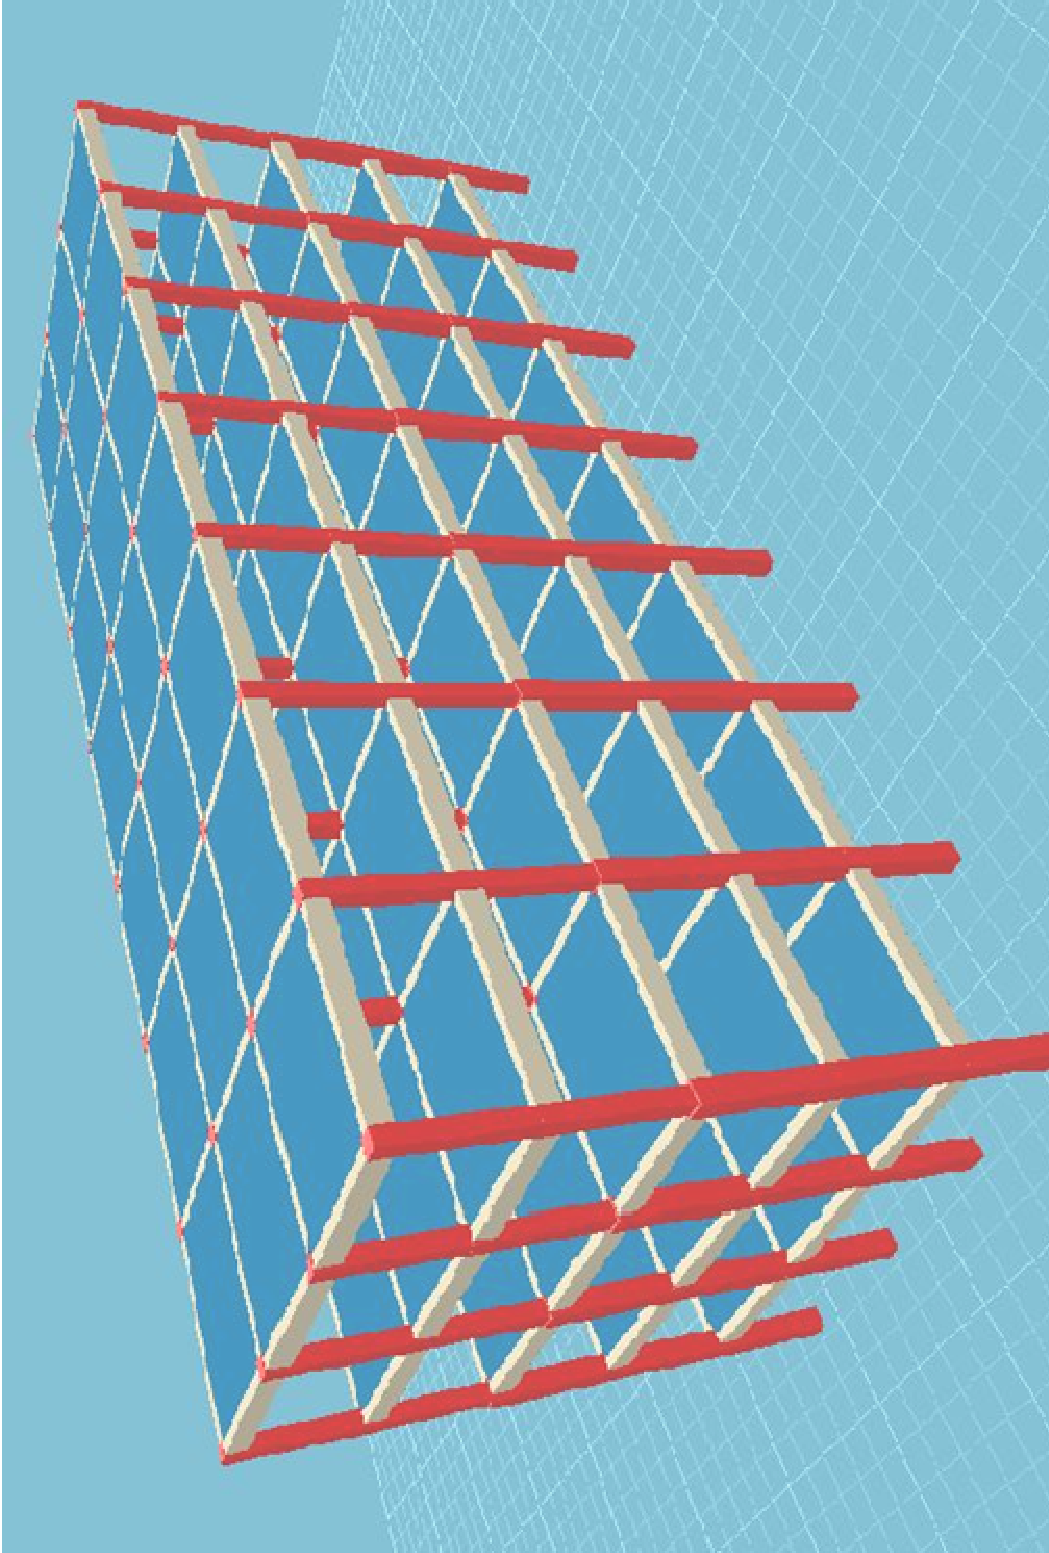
8 açıklıklı binalara ait tipik kat planı
